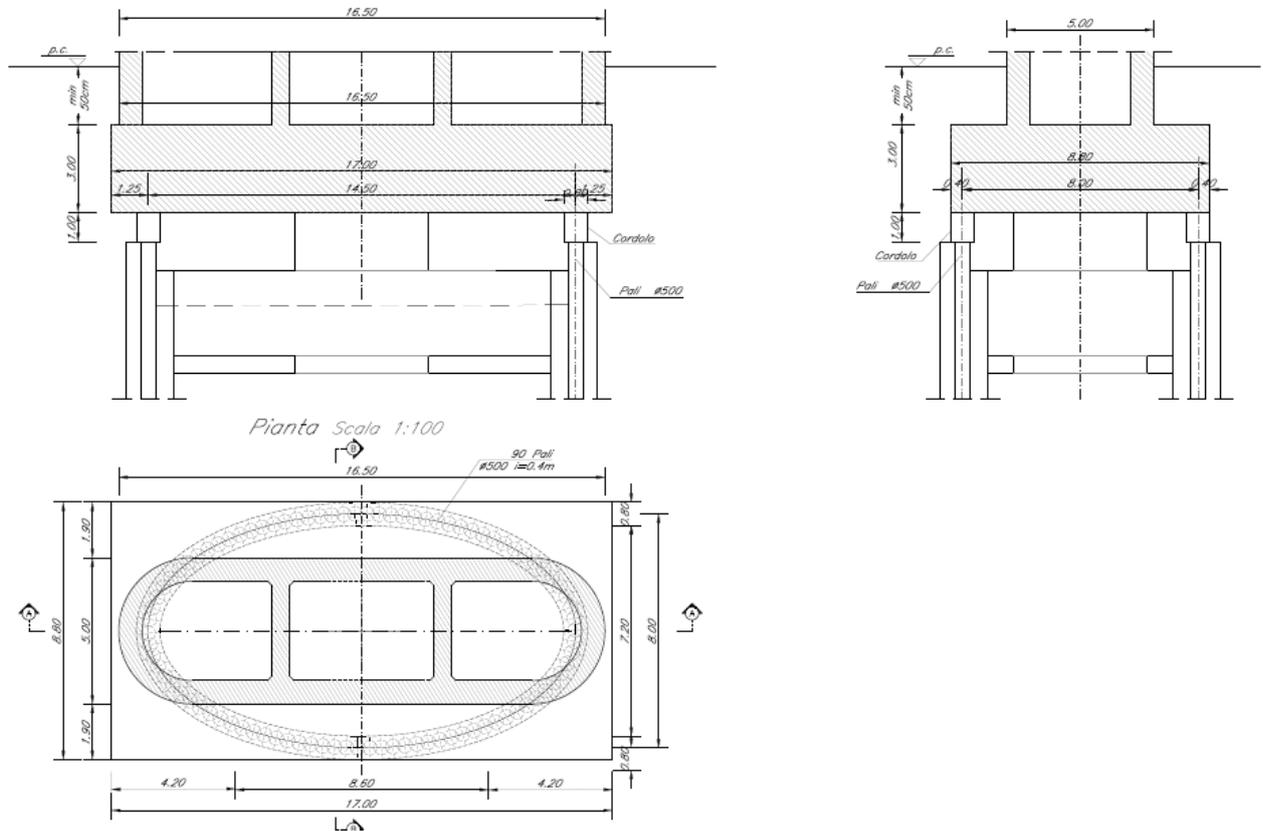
stralcio carpenteria fondazione con singolo pozzo ellittico 8x14.5m
